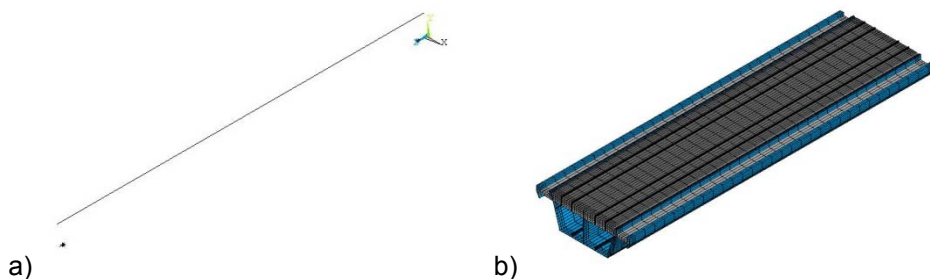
Modello Mono - Trave del viadotto Sesia: Vista generale (a), Vista generale con estrusione della sezione resistente degli elementi (b).
